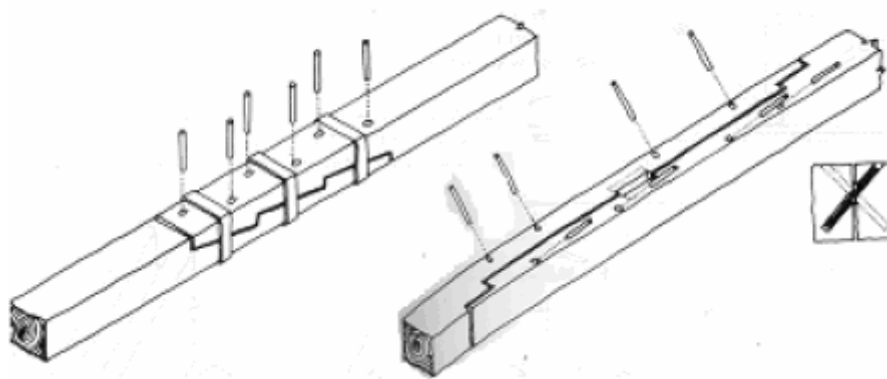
Reforço de linhas com cavilhas e cintas metálicas (Arriaga, F., 2002)
